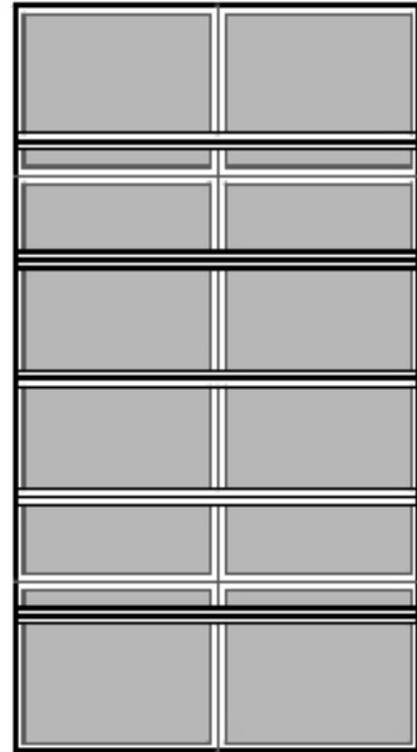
Estudo Solar Fachada Rua São Paulo
